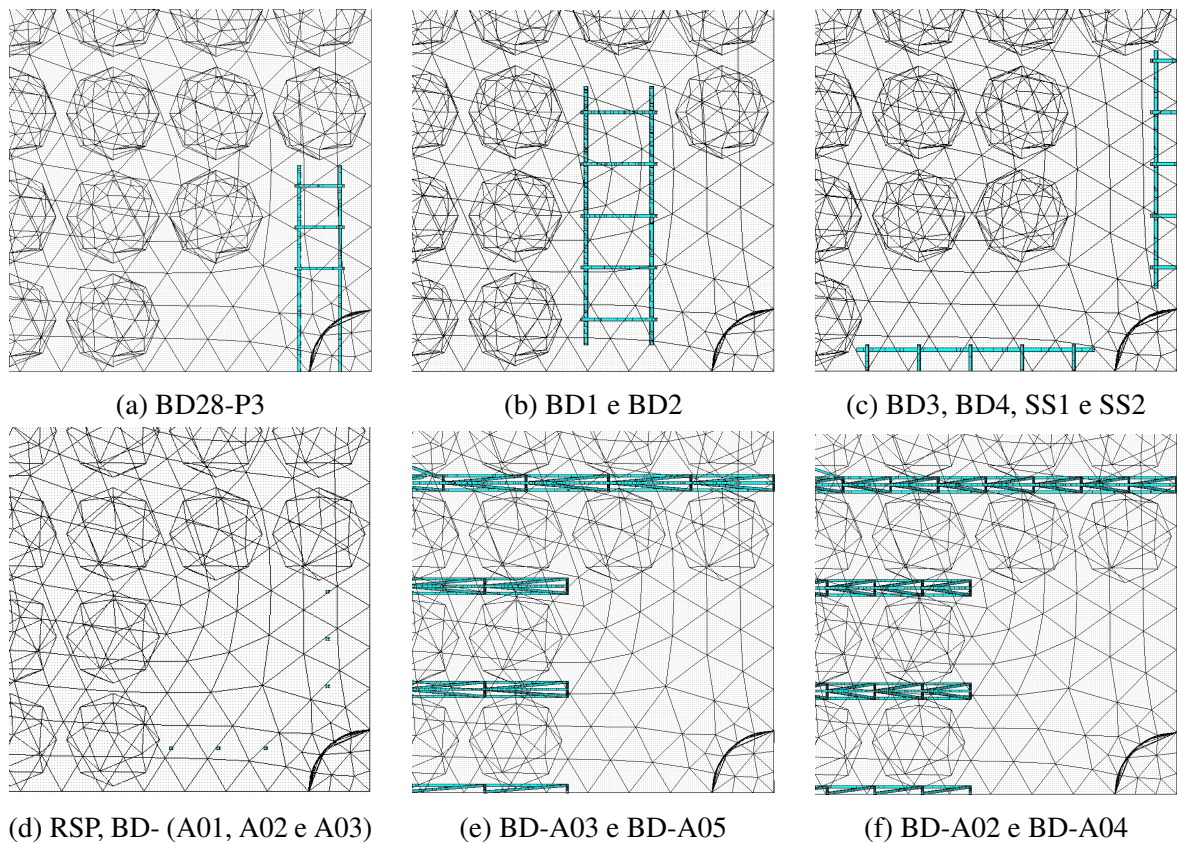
Modelagem das armaduras de cisalhamento (fonte: Autor)
